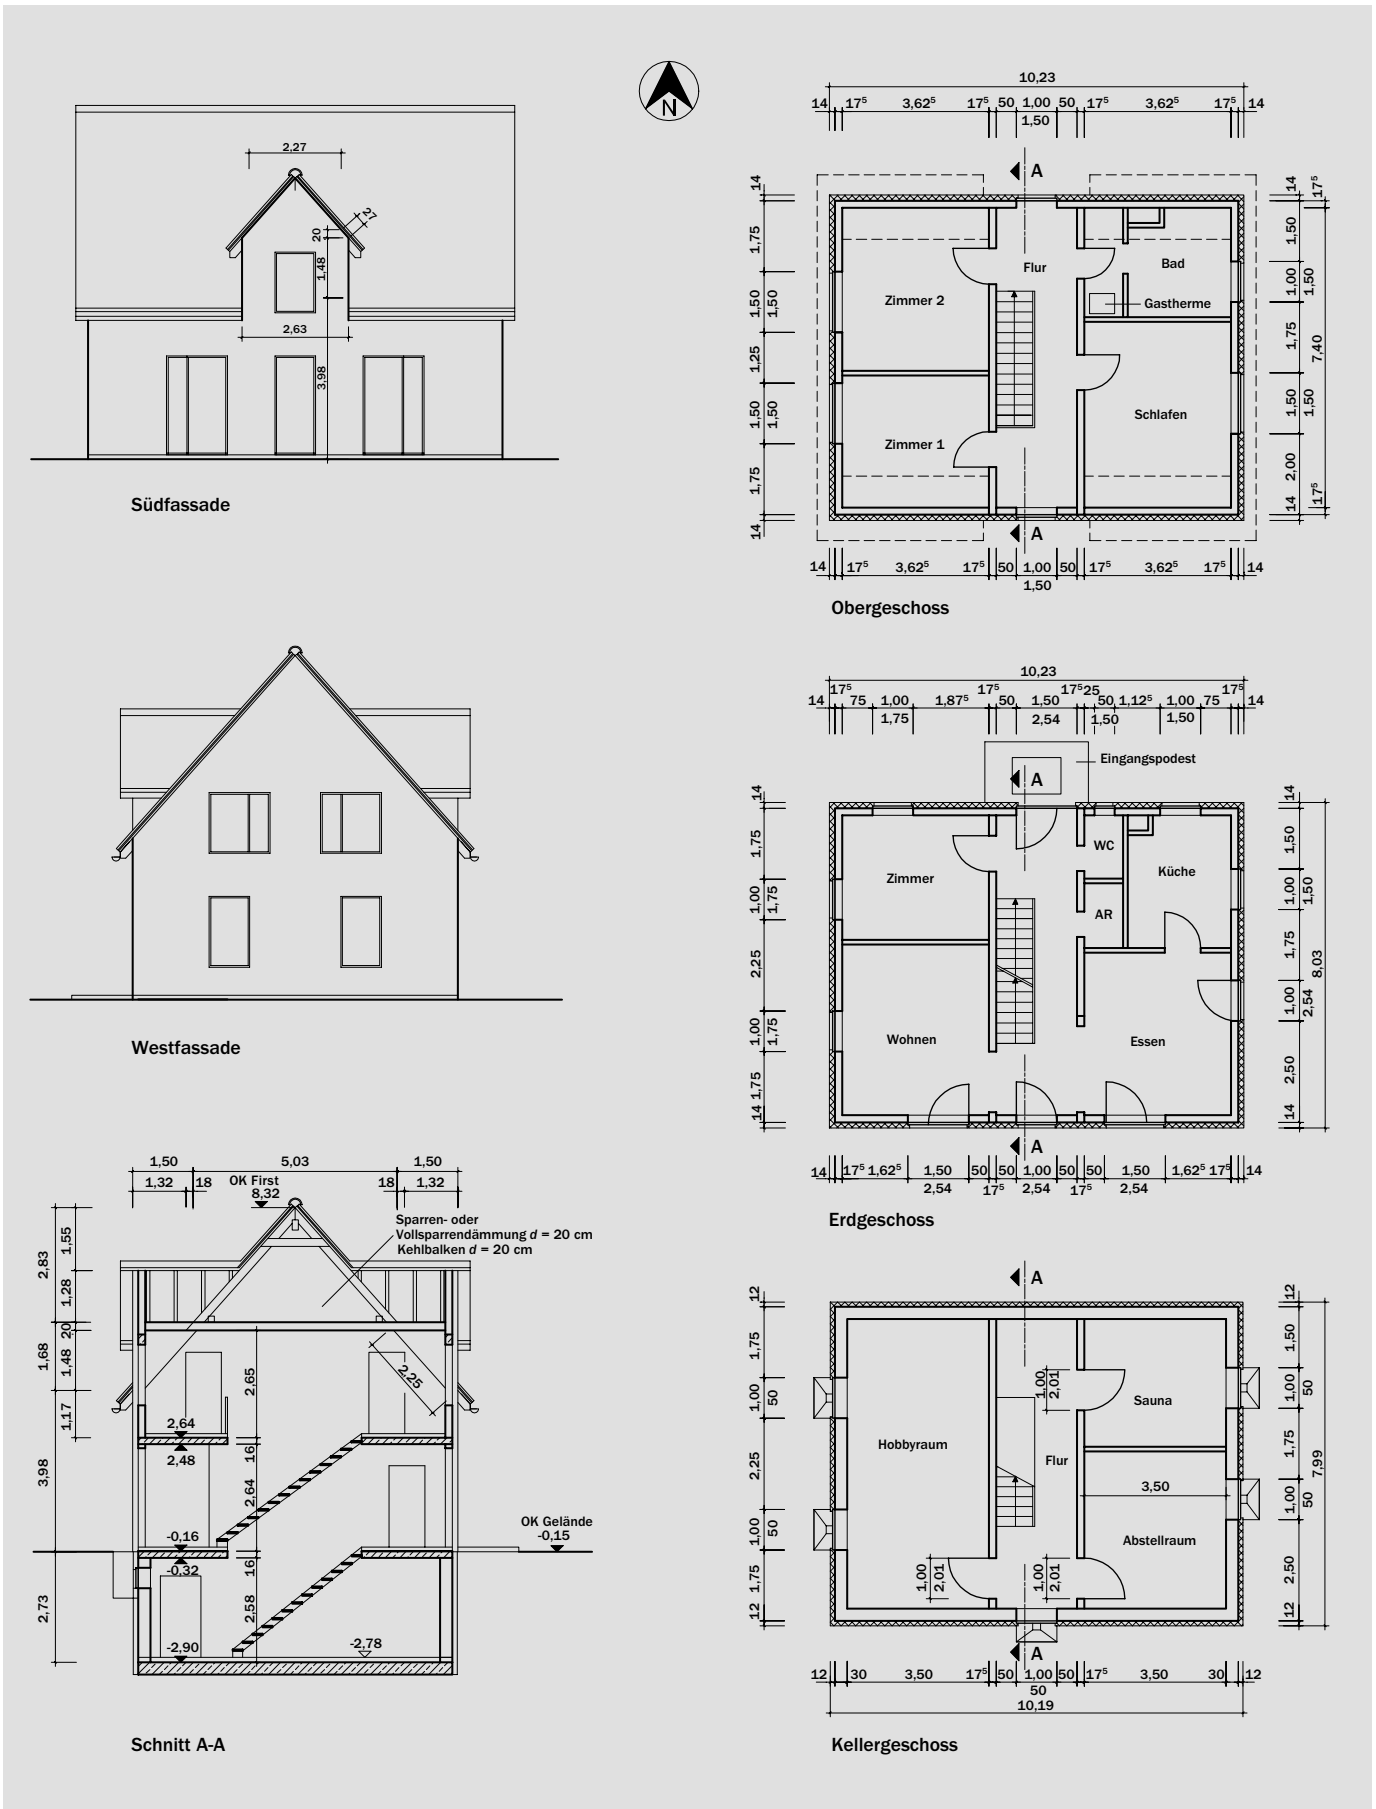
Beispielgebäude: Ansichten, Schnitt, Grundrisse
